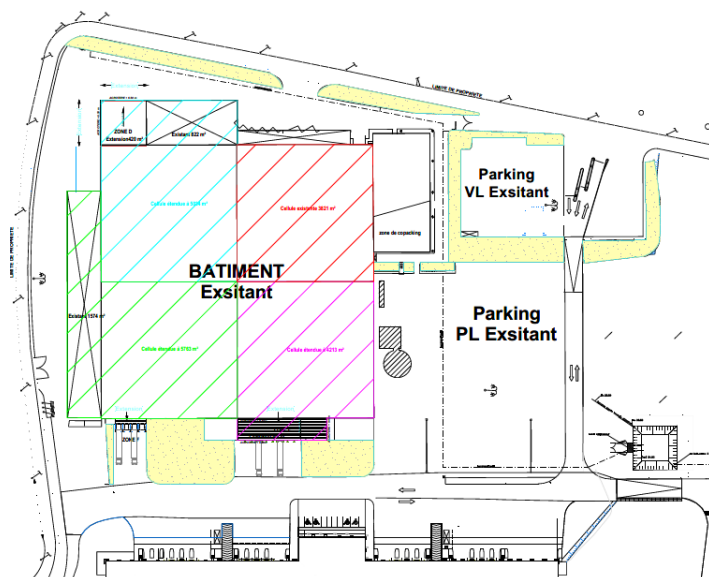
Plan du bâtiment bas (Ex MURPART) (source : GSE)
